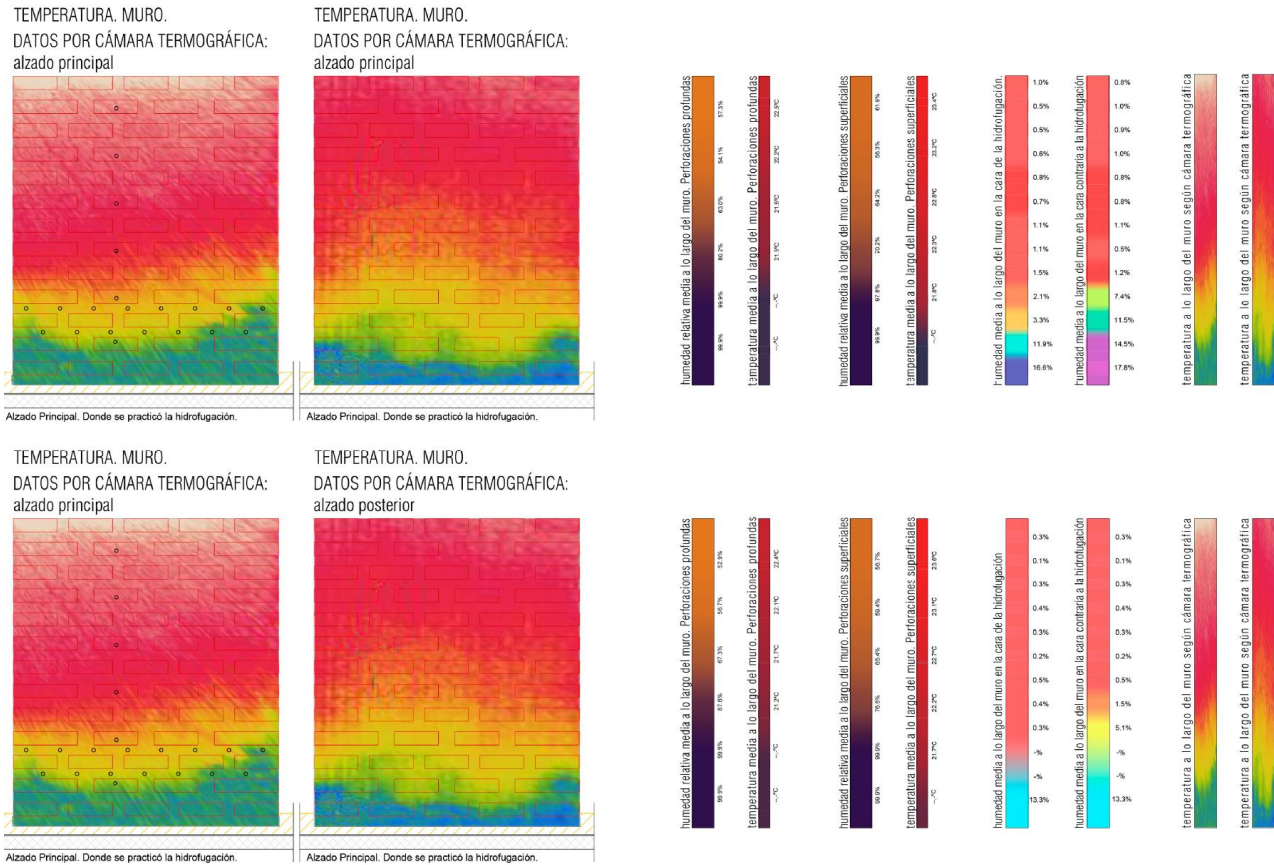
Alzados muro de 1 ½ asta de tejar moderno con barrera hidrófuga.
